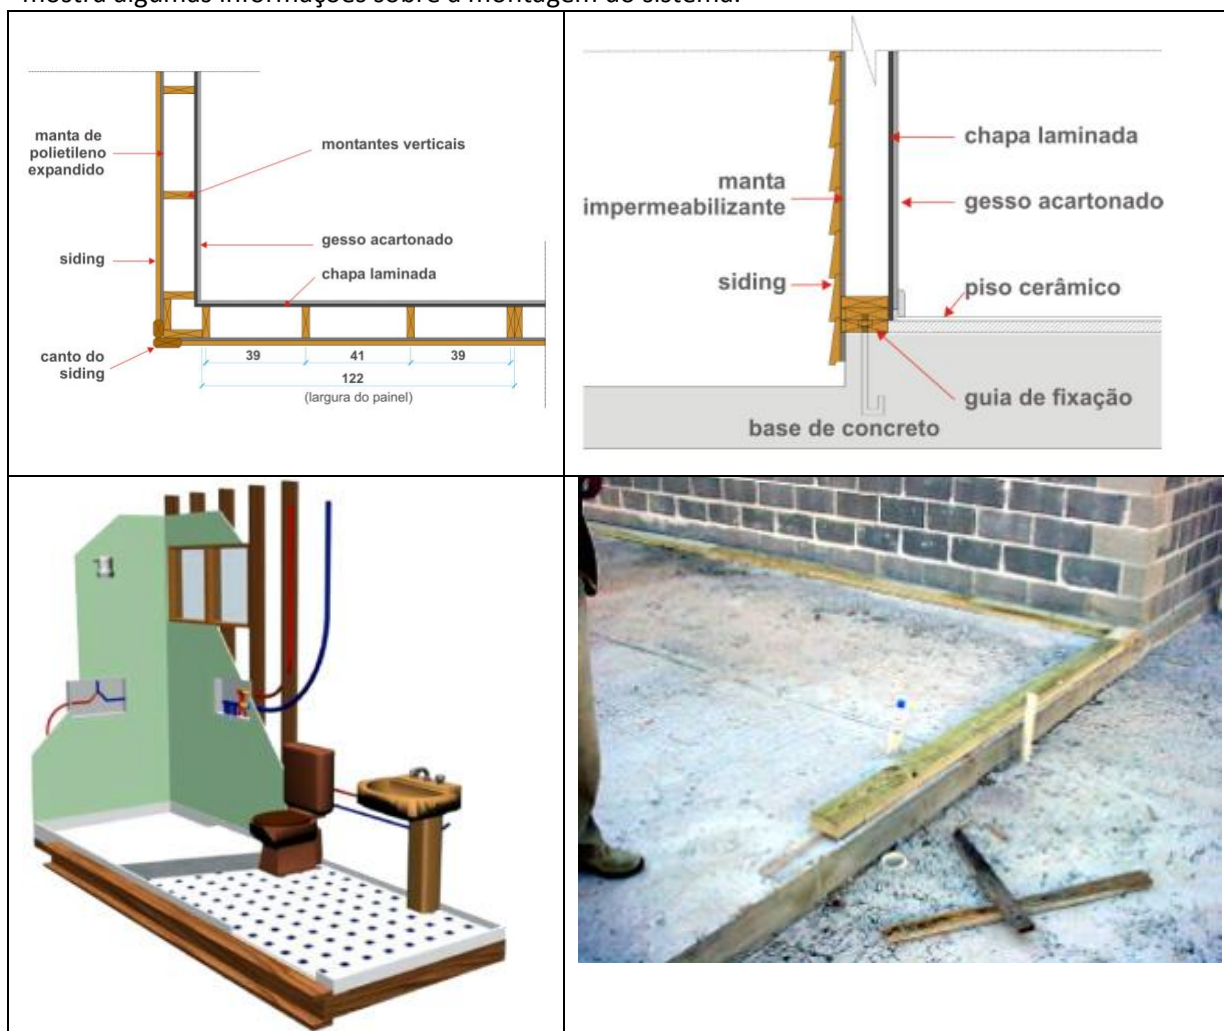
Detalhes de montagem em planta baixa, corte, montagem do Bwc, preparação do piso e marcação das dimensões. Fonte: SZÜCS (2010). 27
